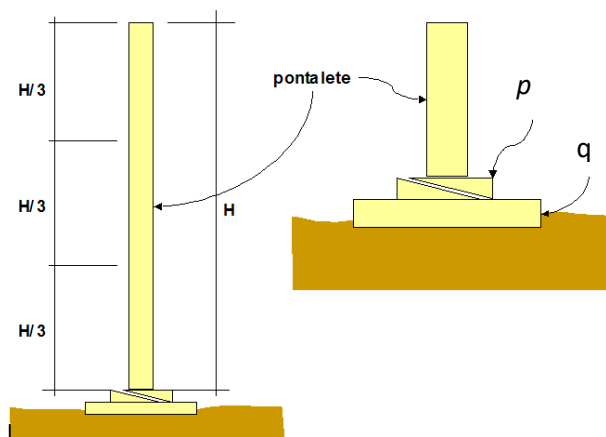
Escoramento de fôrmas de lajes (Fonte: Adaptado de Azeredo, 2018).
